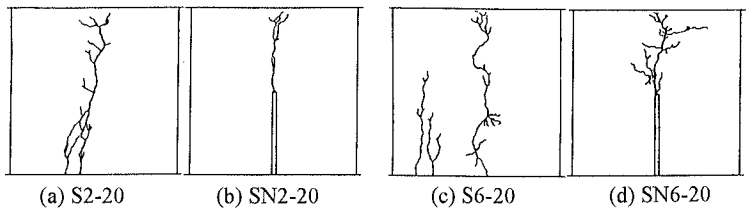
ひび割れ図の一例（はり高さ：20cm）
